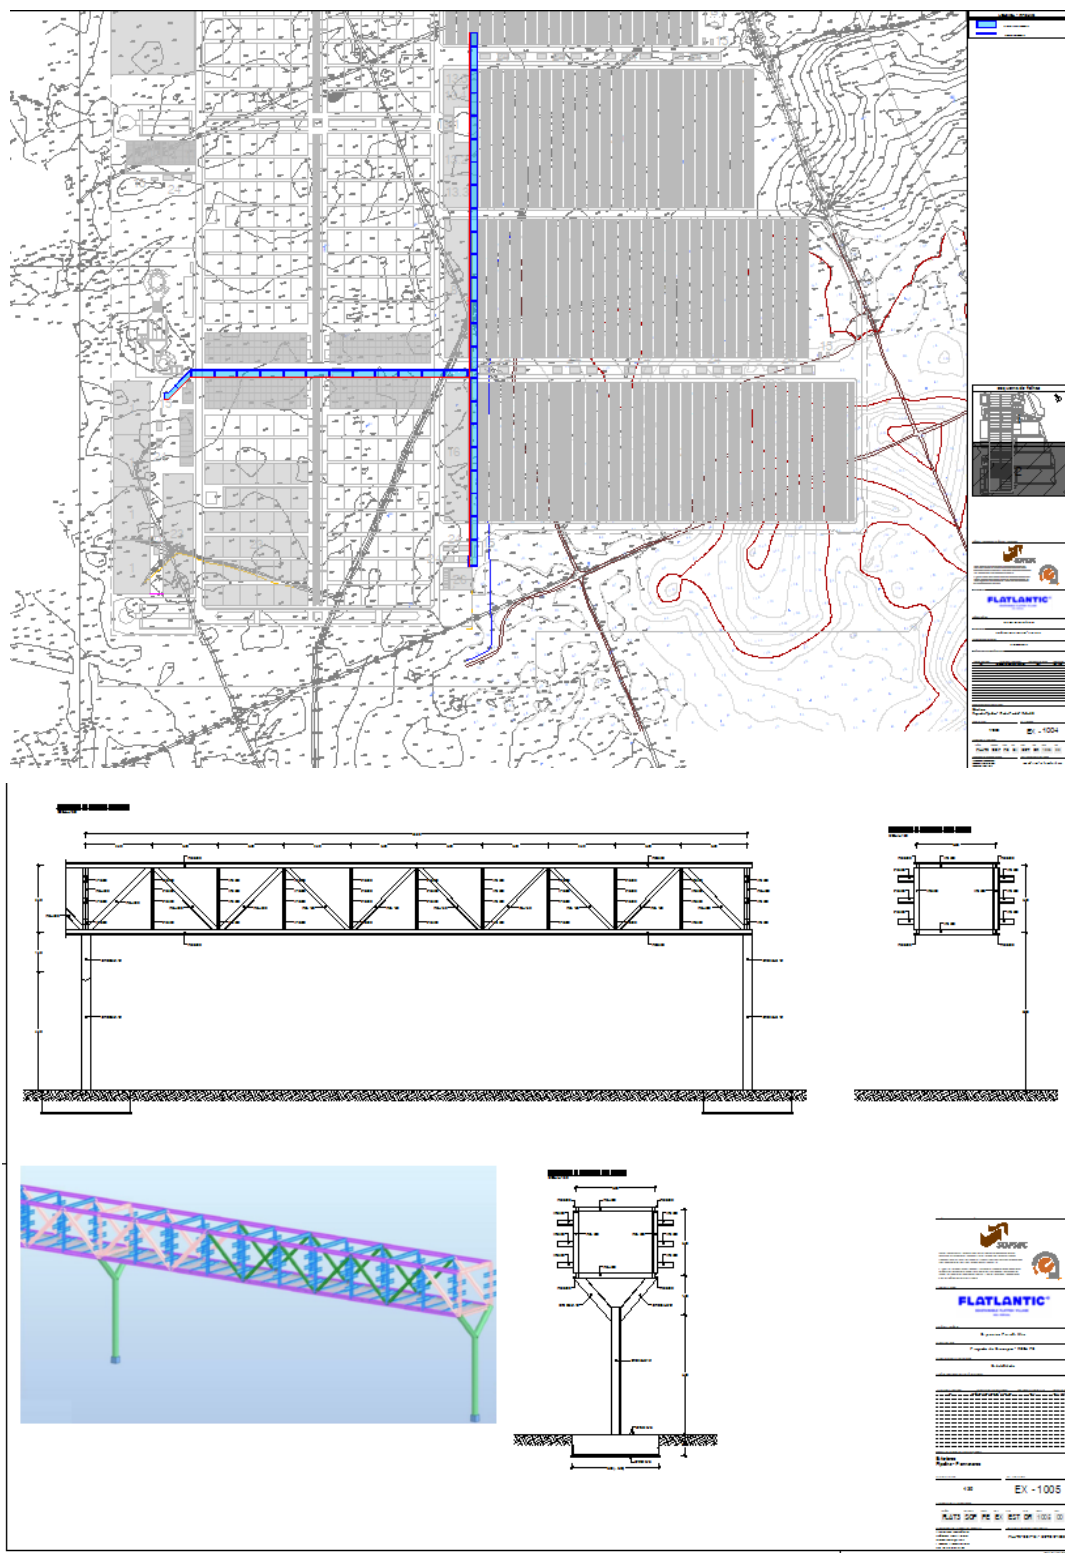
Implantação do pórtico de distribuição de água salgada (figura de cima) e pormenor do pórtico (figura de baixo)
